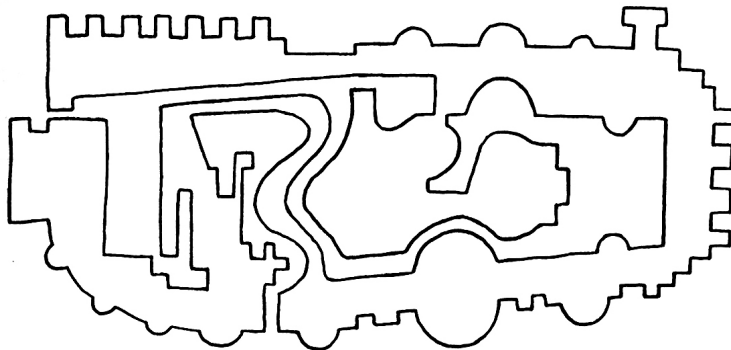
Grundriß einer prähistorischen Siedlung (nach M. Wilk)
